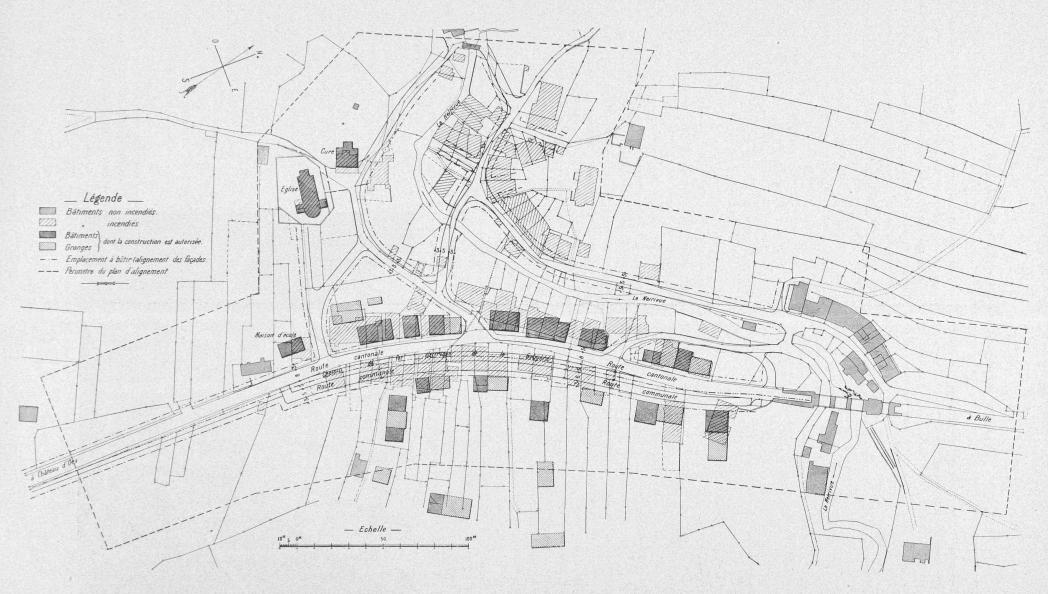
PLAN DE RECONSTRUCTION DU VILLAGE DE NEIRIVUE (HAUTE-GRUYÈRE)
